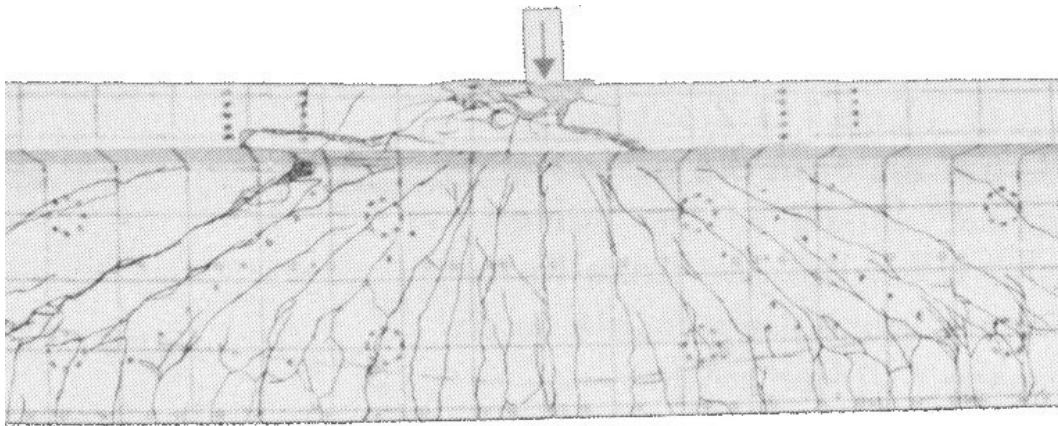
Rissbild des vorgespannten Balkens TG 2 aus [3.2] (Ausschnitt)
